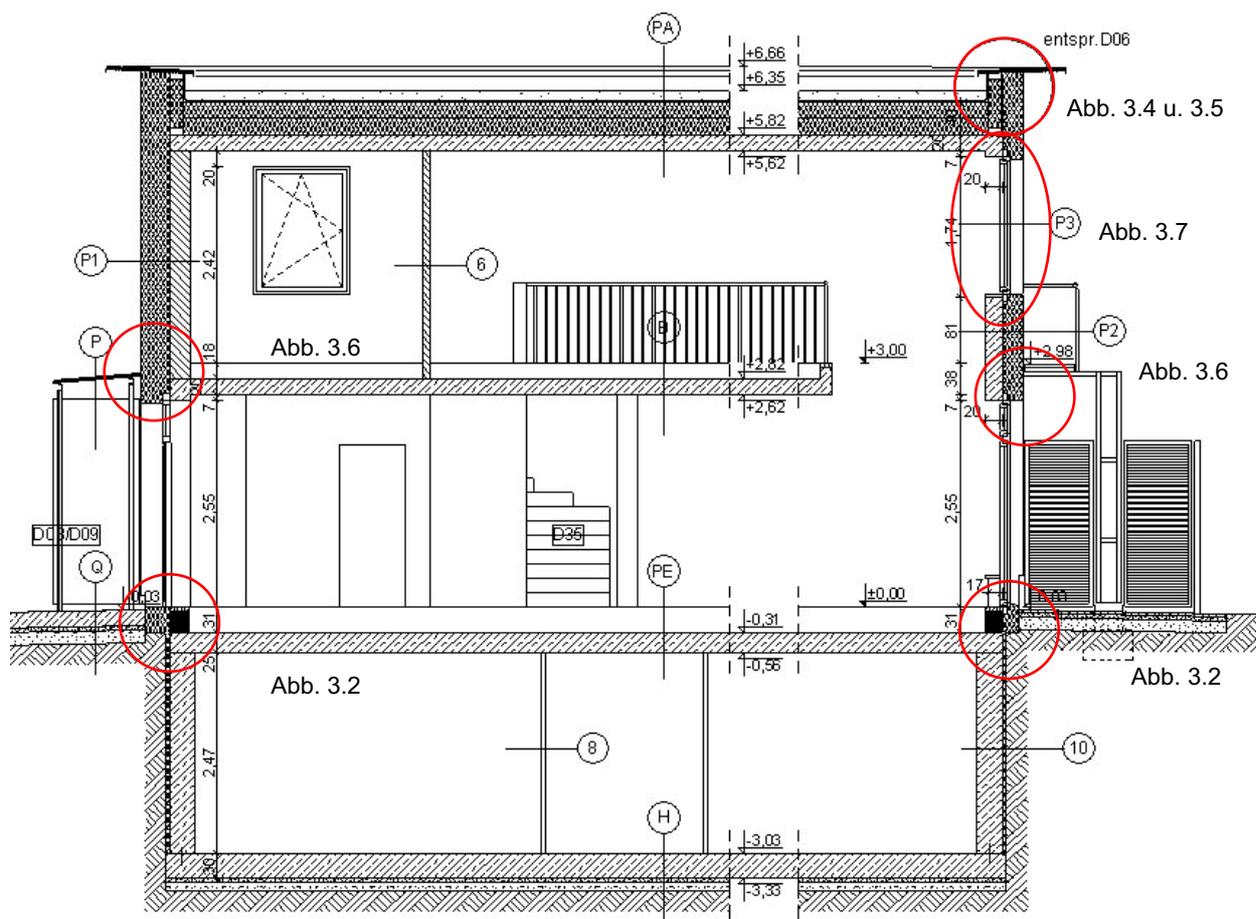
Querschnitt durch das Haus 1 mit Angabe der Detailpunkte
